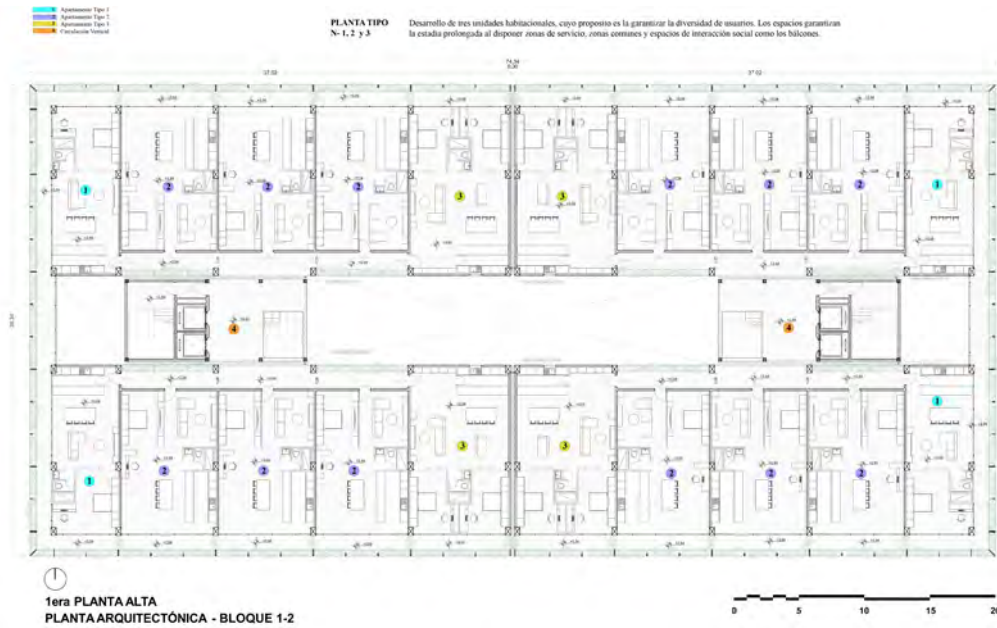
Planta alta tipo replicada en los niveles 1, 2 y 3 en los bloques 1 y 2
